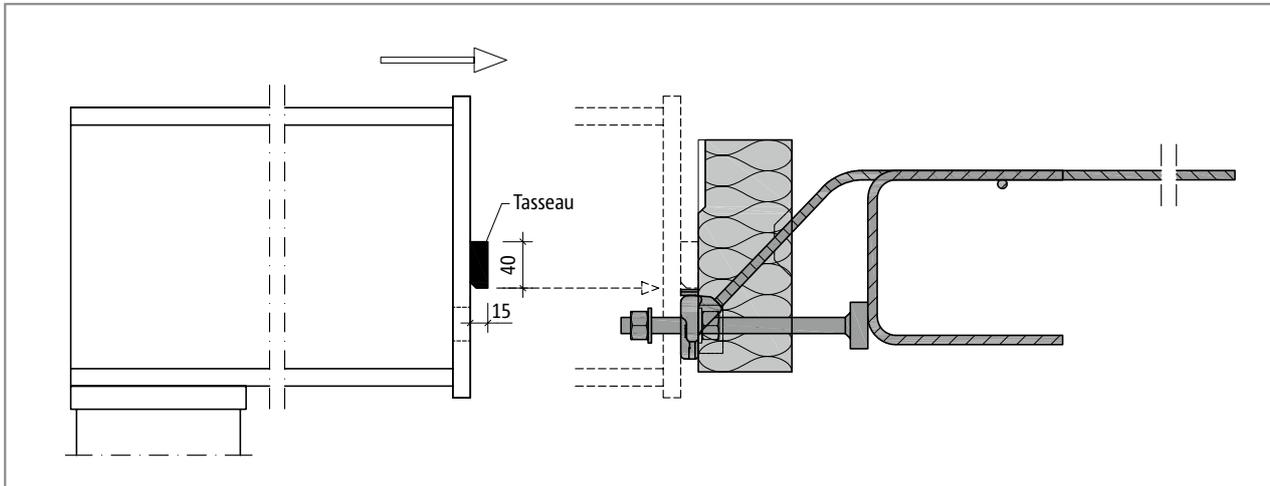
Schöck Isokorb® T type SQ : montage de la poutre en acier
